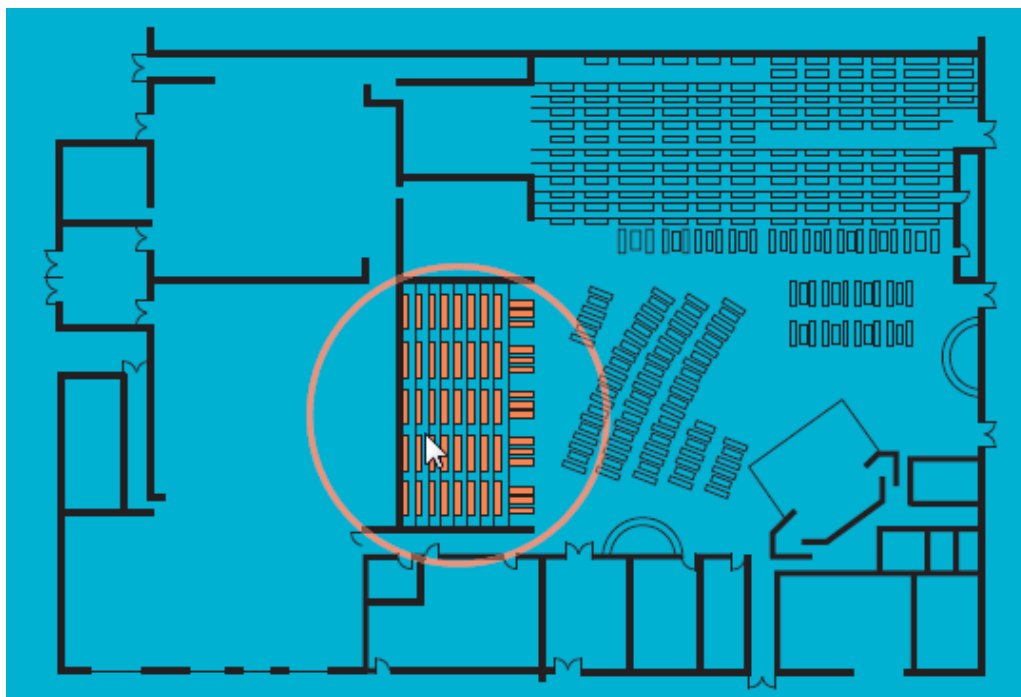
Layout della stanza da ballo (Image: Bo Andersson)
